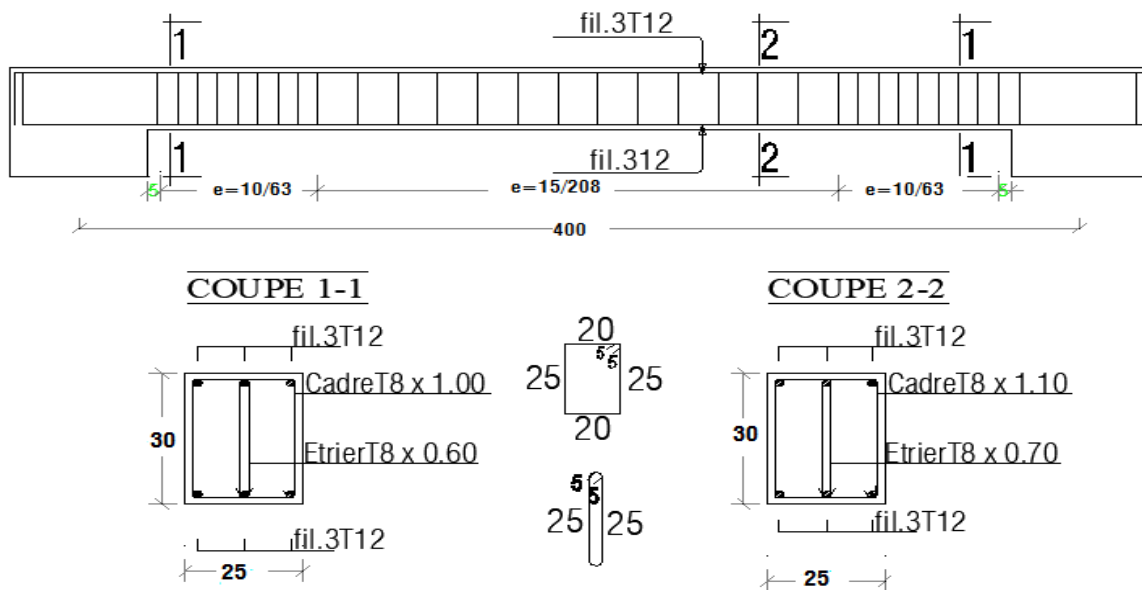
Schéma du ferrailage de la poutre de chaînage
